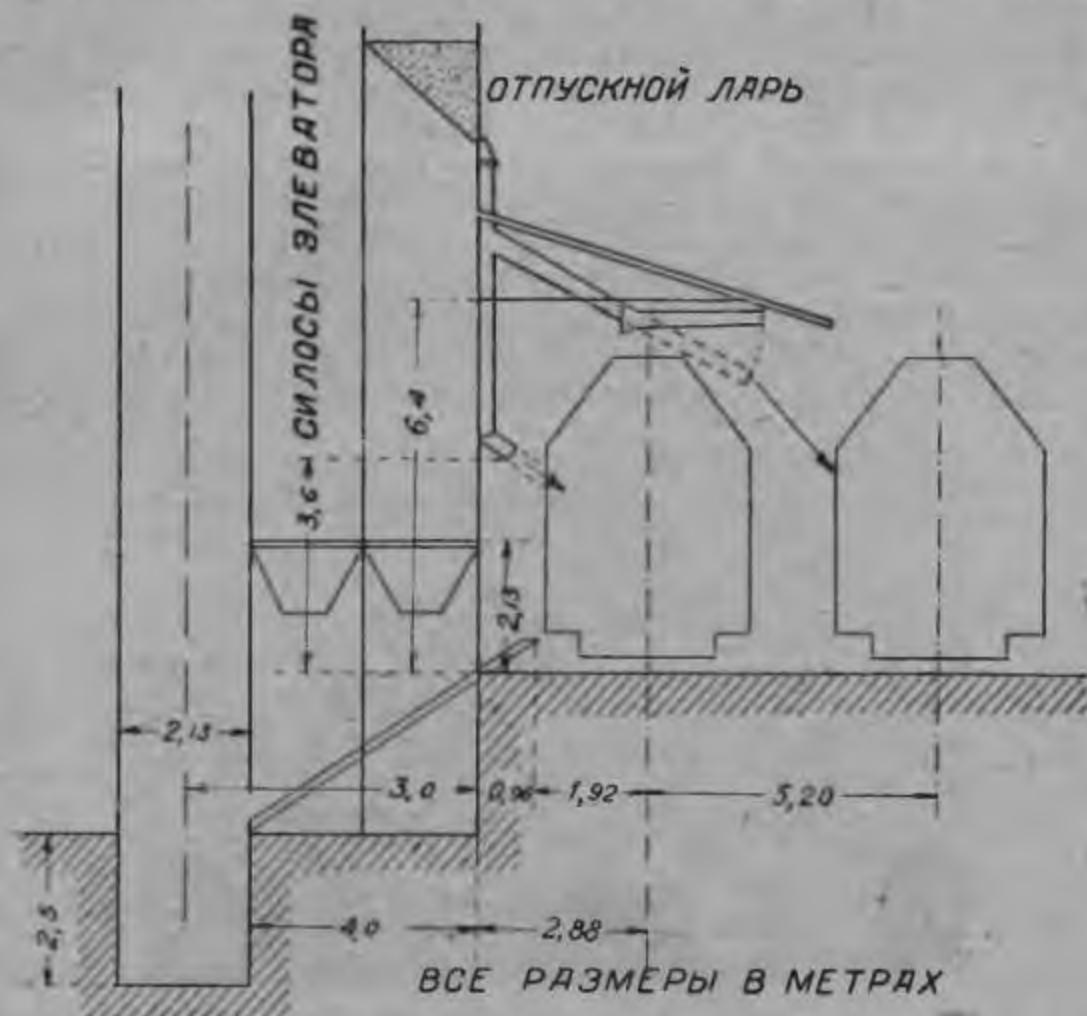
Габаритная схема для погрузки зерна из склада (элеватора) в вагон.
